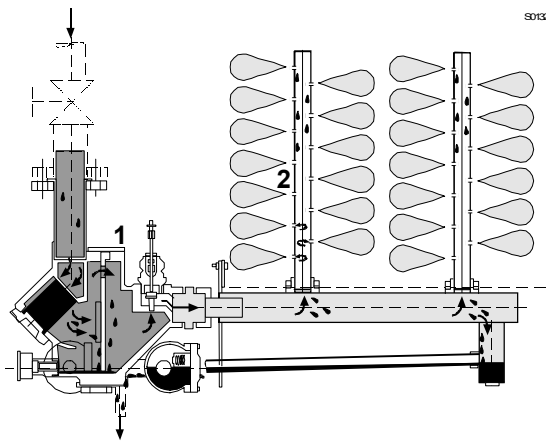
Dampf-Luftbefeuchter, Prinzip
